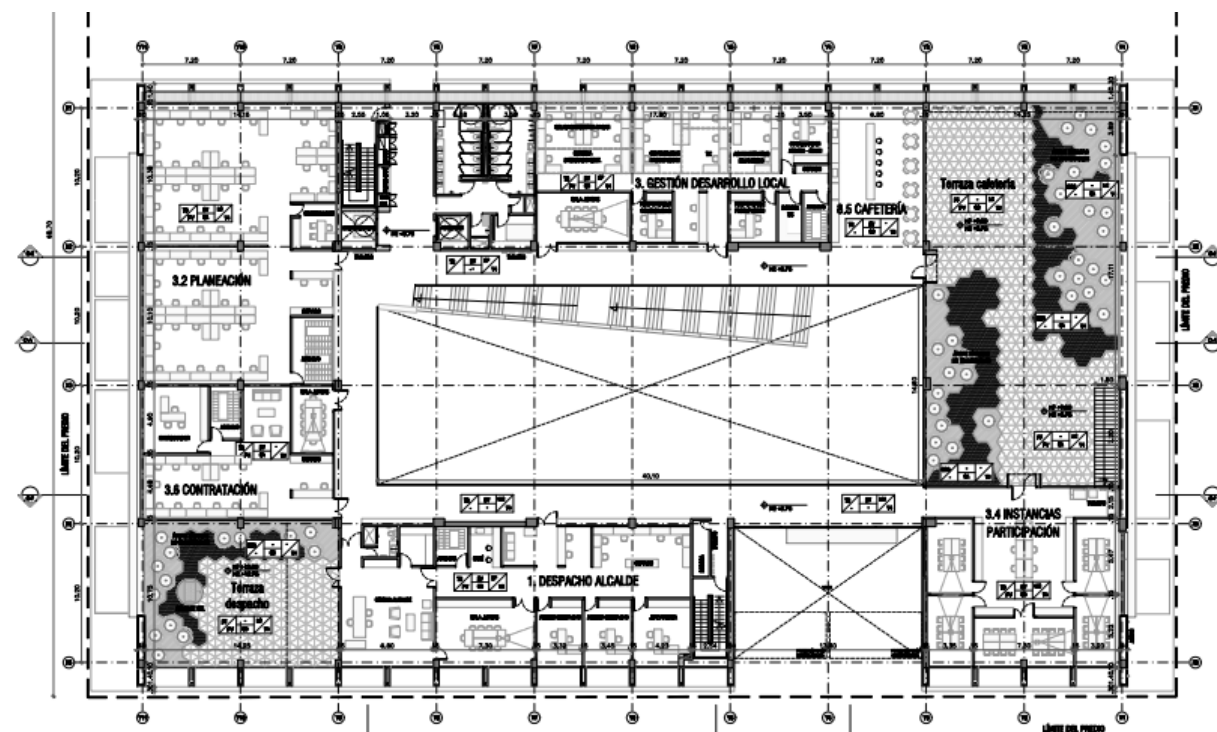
Planta piso 3. Fuente: Planos arquitectónicos.
